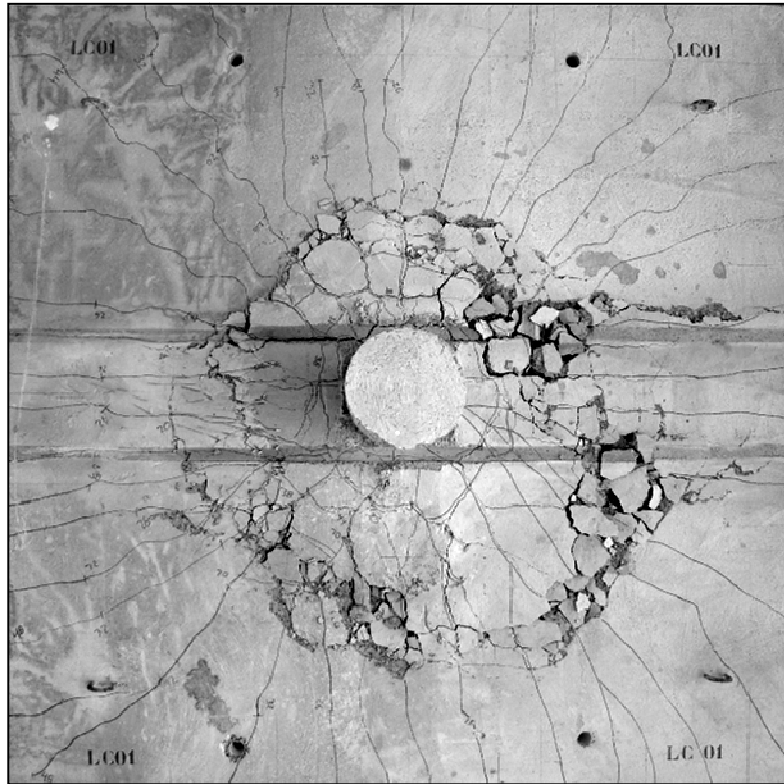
Mapa de fissuração da laje LC01
